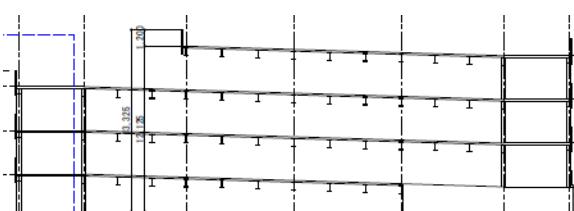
(2) 立体駐車場断面図 (A-A 断面)
